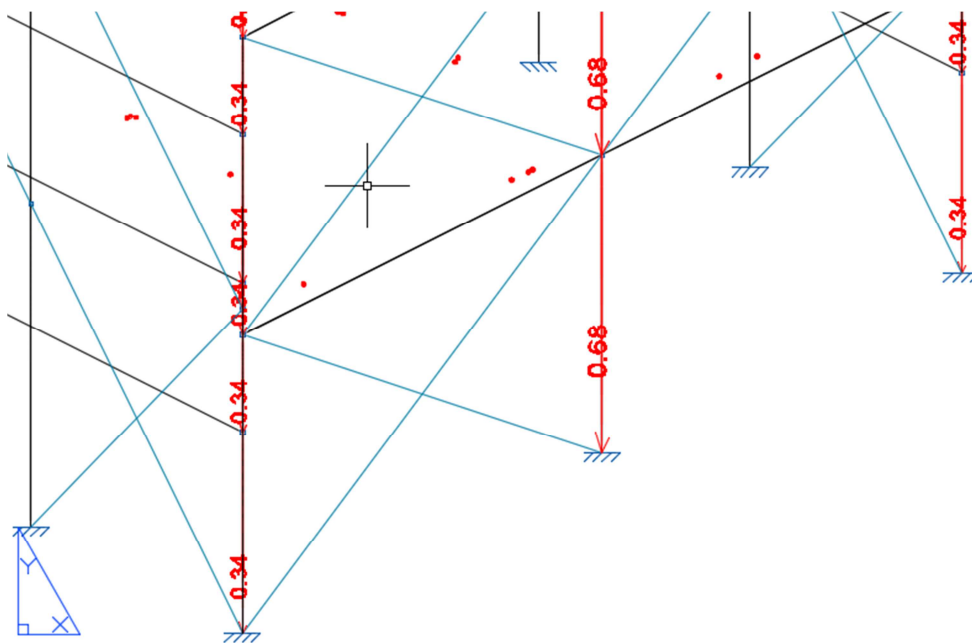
Carga repartida de la chapa de fachada sobre pilares de pórtico frontal
